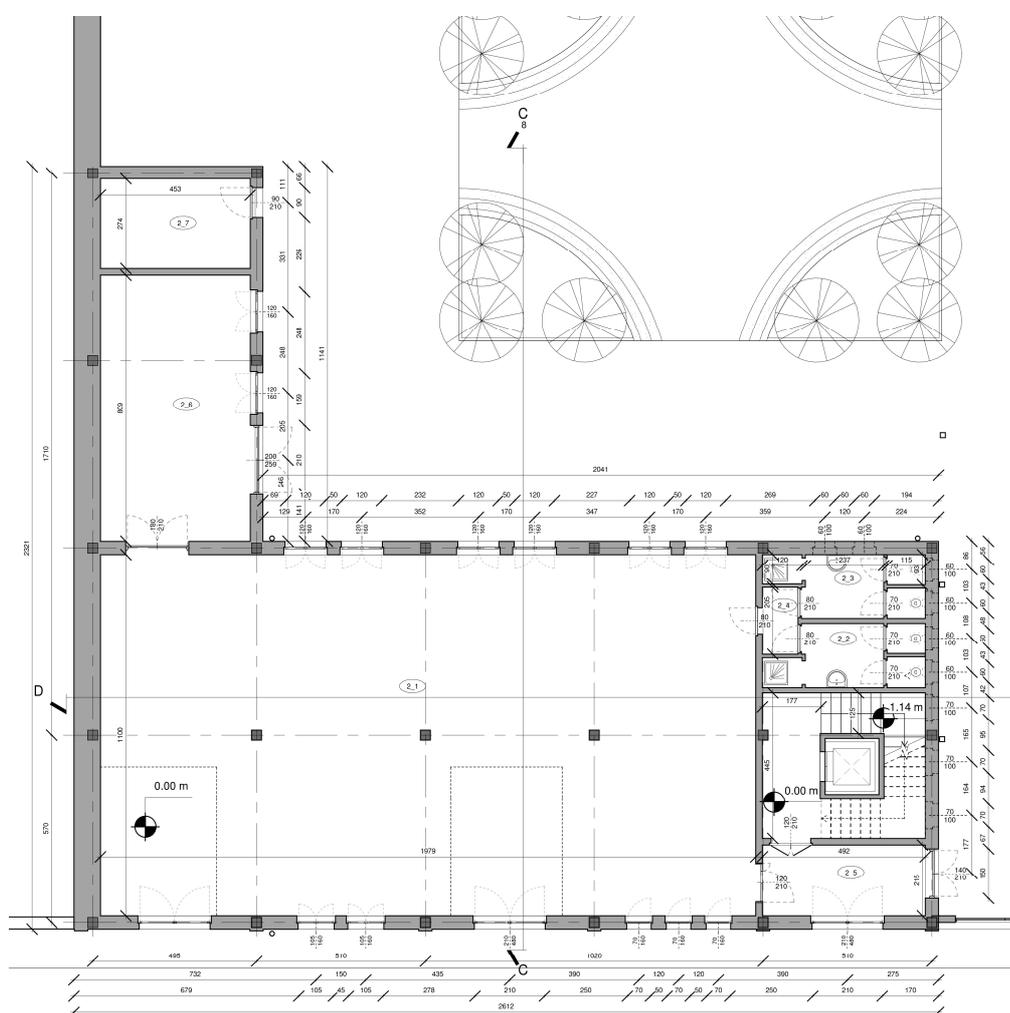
Piano Terra Atelier (Tav. n° 6 scala 1:100)
